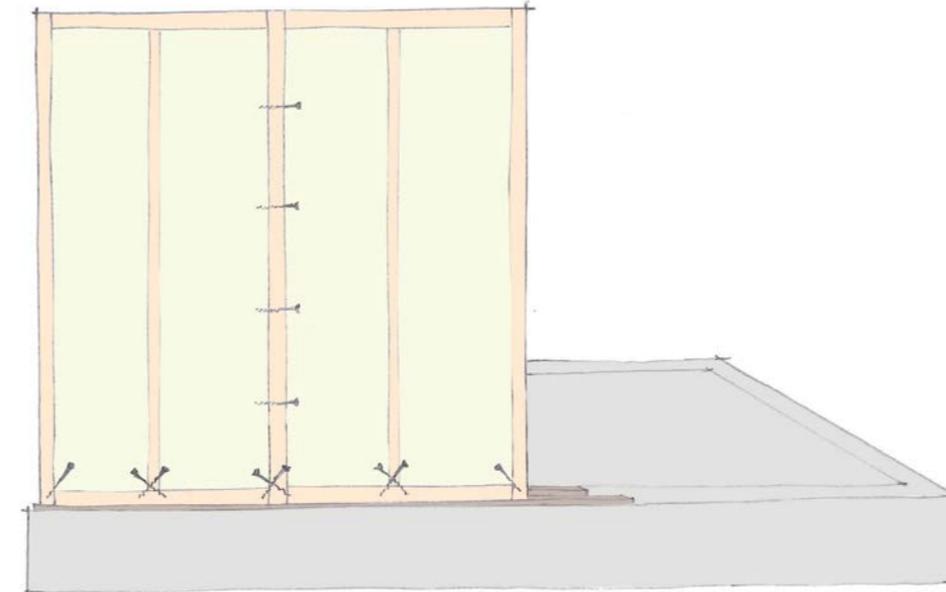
Colocación de paneles sobre el zuncho de cimentación.
